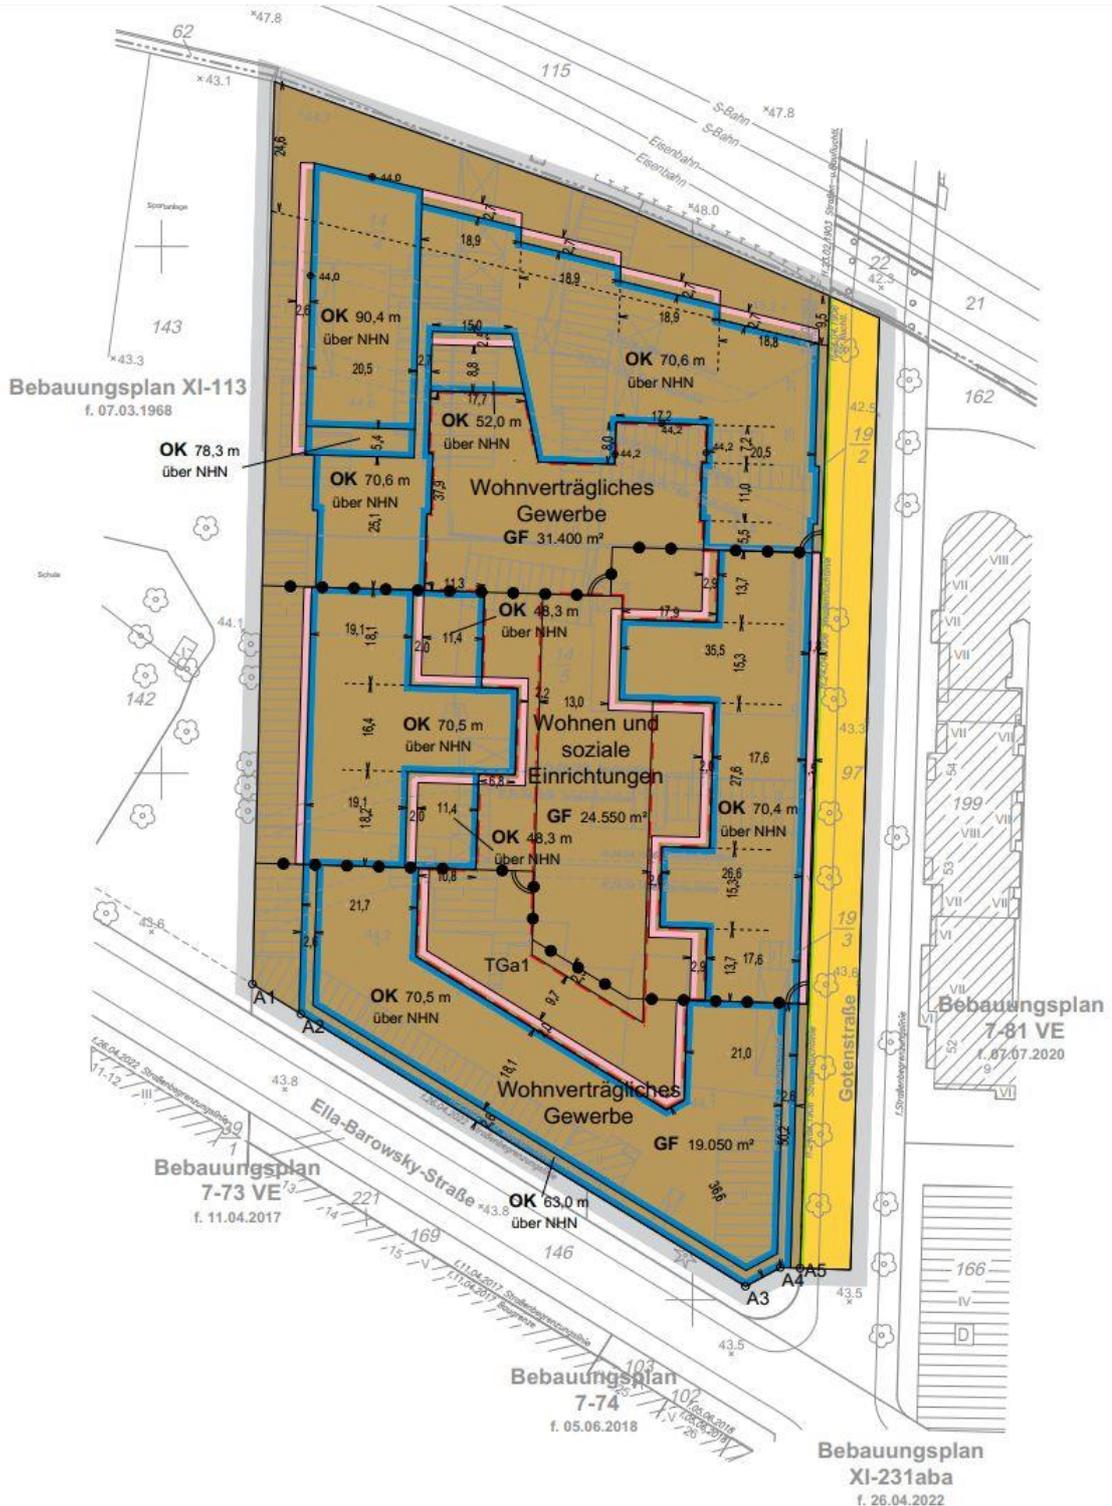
Vorhabenbezogener Bebauungsplan 7-100 VE für das Grundstück Gotenstraße 26-33 / Ella-Barowsky-Straße 48-61 im Bezirk Tempelhof-Schöneberg, OT Schöneberg. Entwurf vom 23.04.2024
